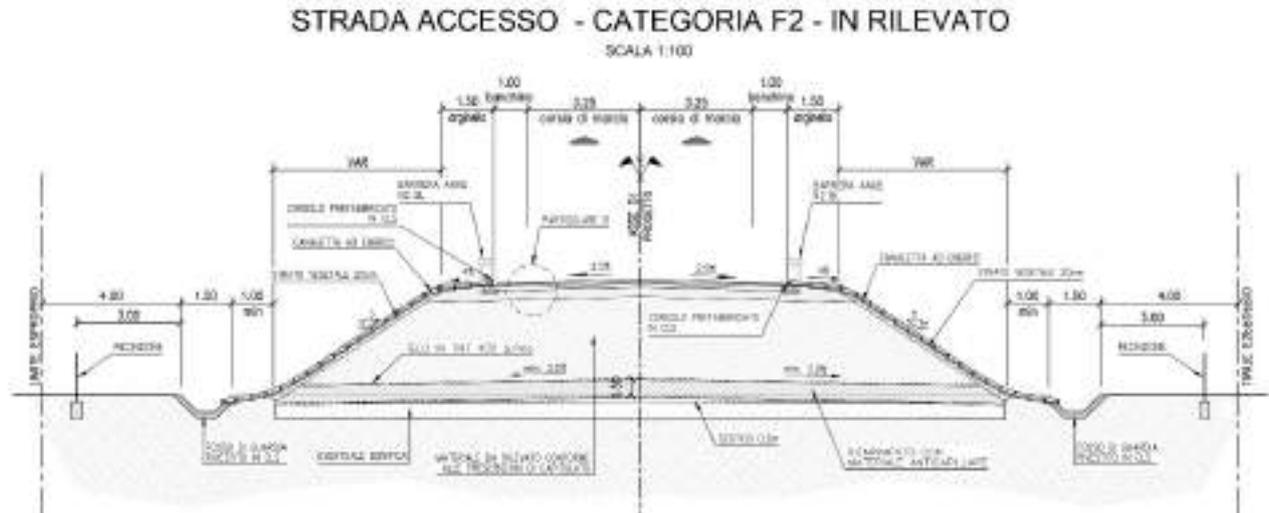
Sezione tipo in rilevato dell'asse secondario – Strada di Accesso alla Dorsale Consortile CASIC.
